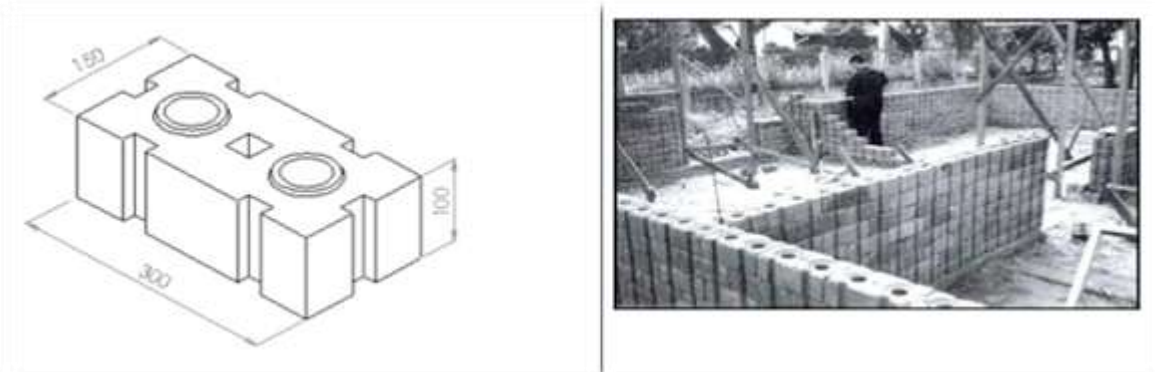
Sistema constructivo Thai (Simion, 2009)
